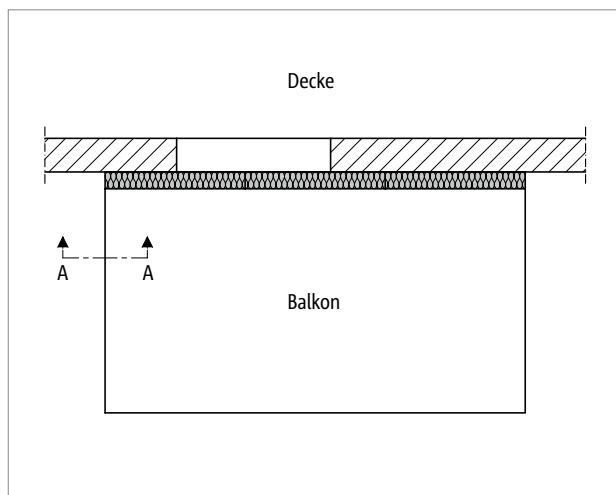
Schöck Isokorb® XT Typ KL, KP: Balkon frei ausragend
